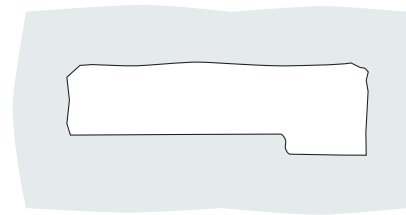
Ungleichmäßiger Deckendurchbruch ohne Belegung
